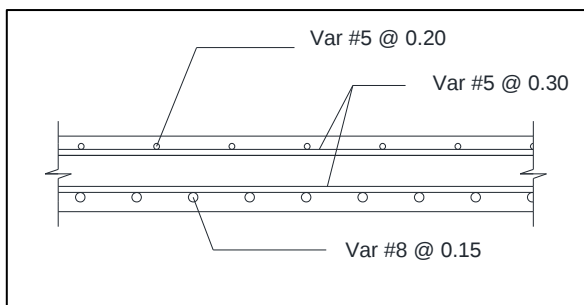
Dimensiones de la losa de concreto armado. Acotaciones en metros.
